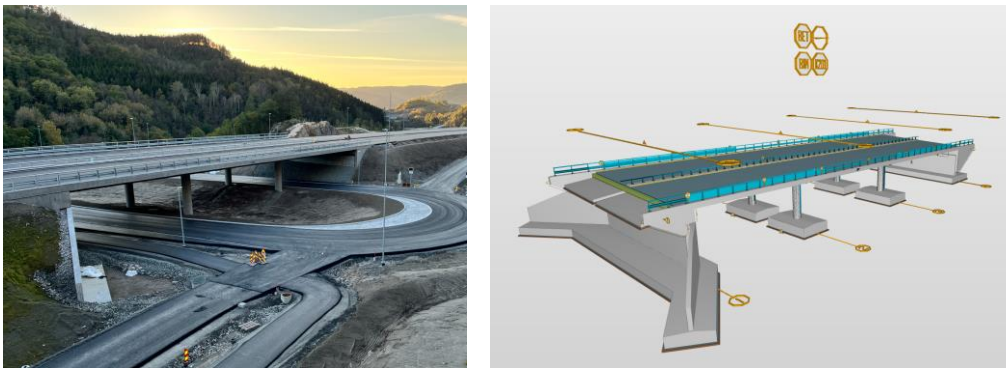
Ponte Raunesteinsli – Fase final da execução da estrutura e vista do modelo BIM de estruturas.
